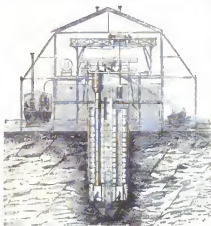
Sezione trasversale d'una pila durante il lavoro di fondazione col sistema ad aria compressa.
